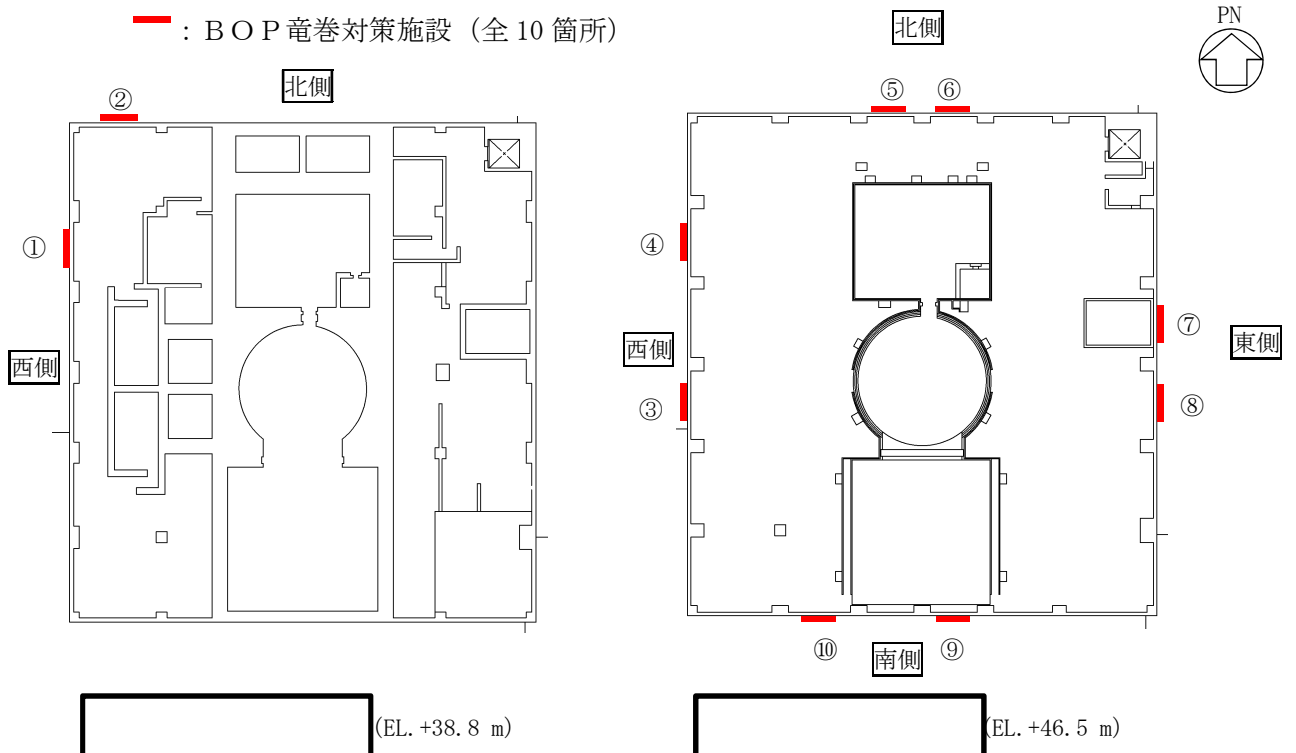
BOP竜巻対策施設配置（建屋平面図）
